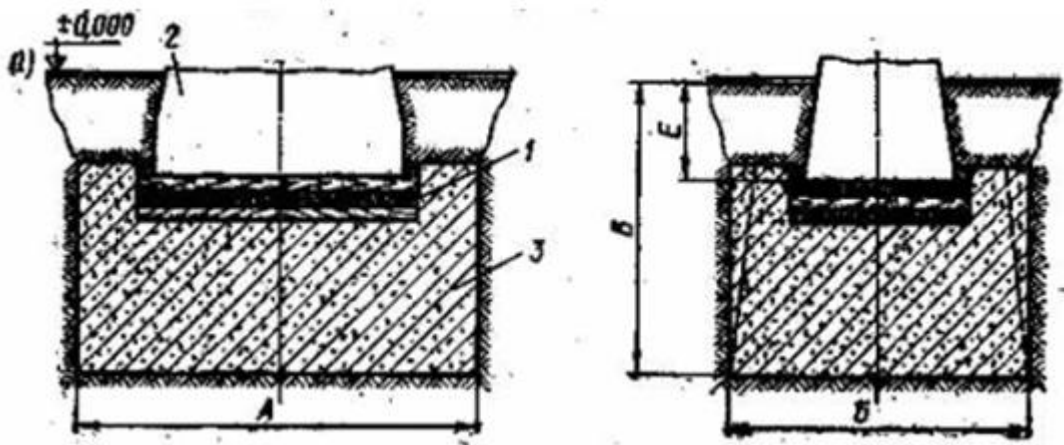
Схемы фундаментов под паровоздушные штамповочные молоты[13]:
